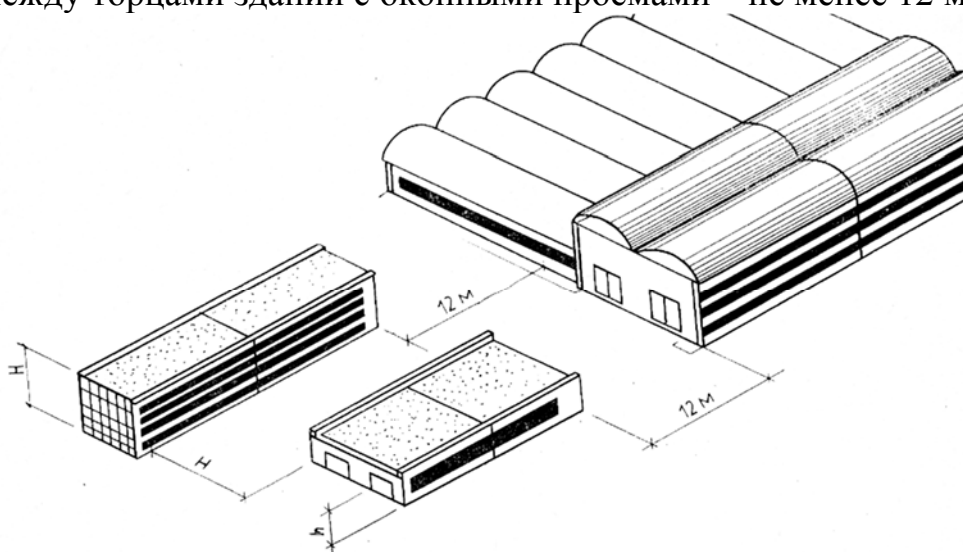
Санитарные разрывы между зданиями, освещаемыми через проемы [38]
